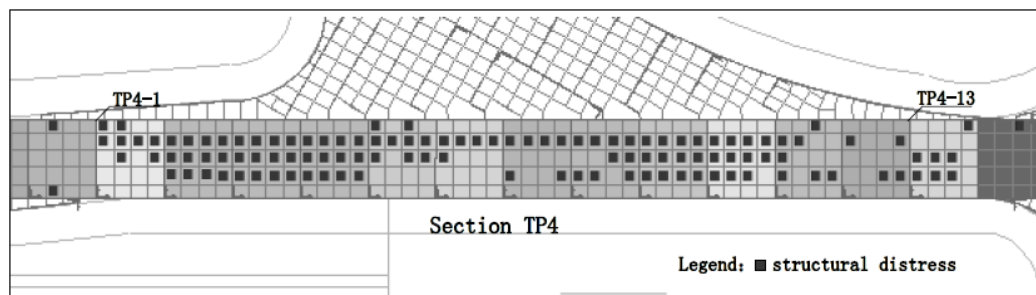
Secciones del pavimento del aeropuerto de Shanghai.
